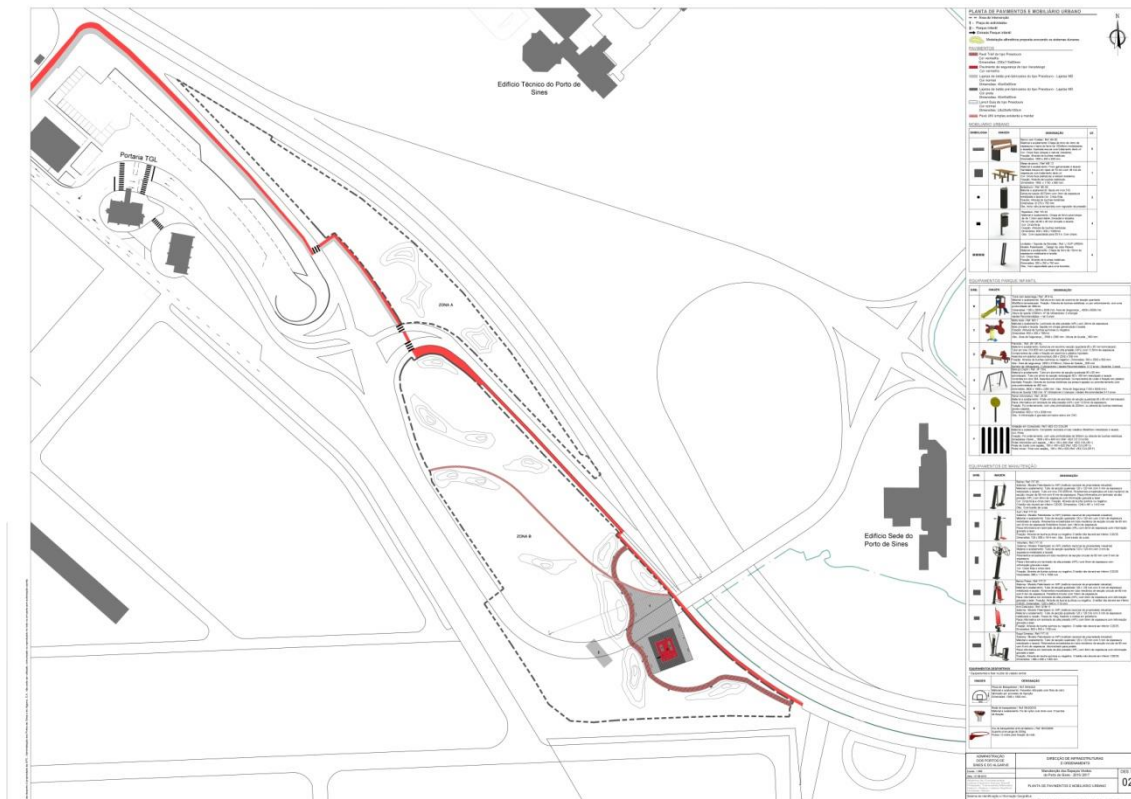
Plano de pavimentos e mobiliário urbano.
